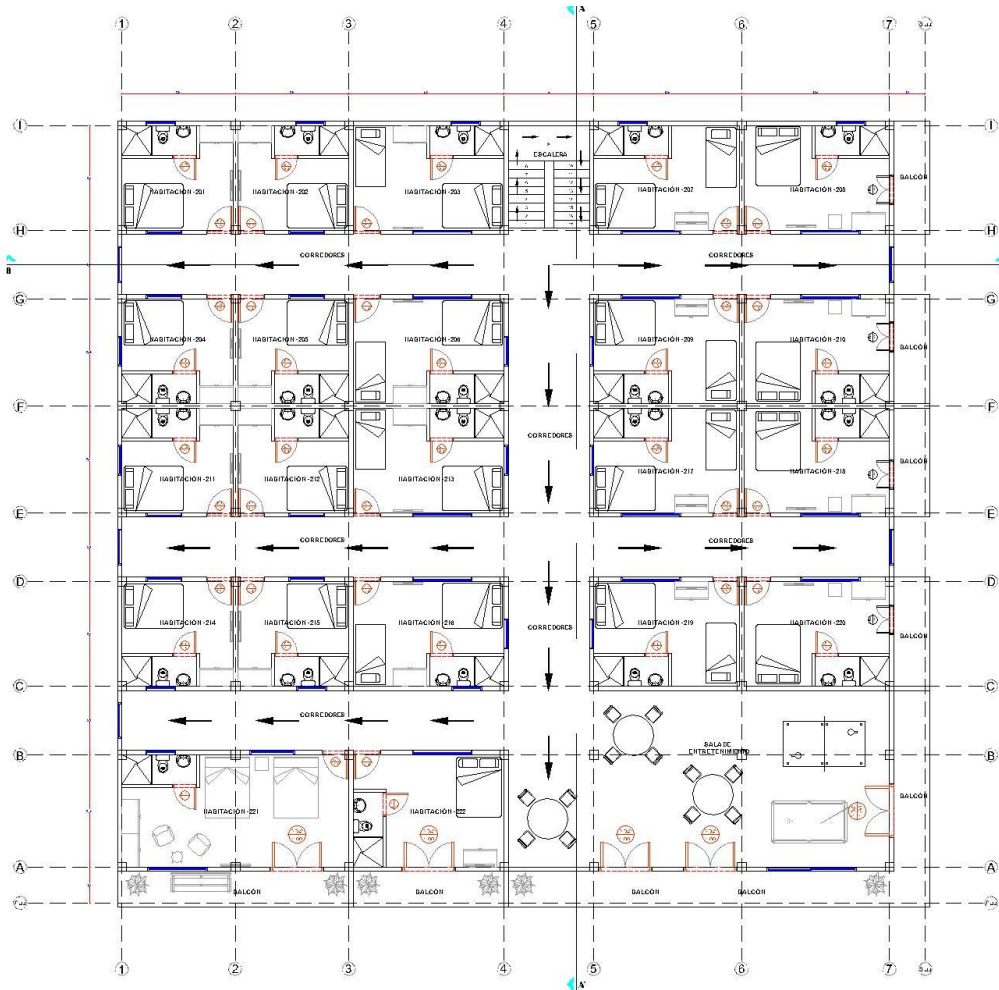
Plano arquitectónico piso tipo (2, 3, 4 y 5) del hotel. Fuente propia de los autores.
